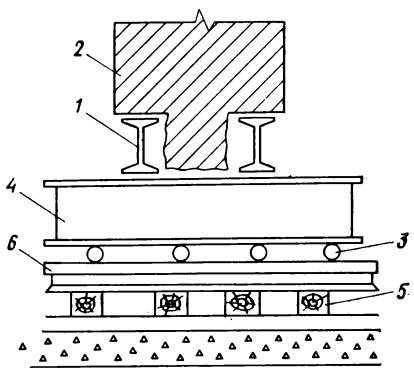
Схема расположения рандбалок и ходовых балок под передвигаемым зданием:
